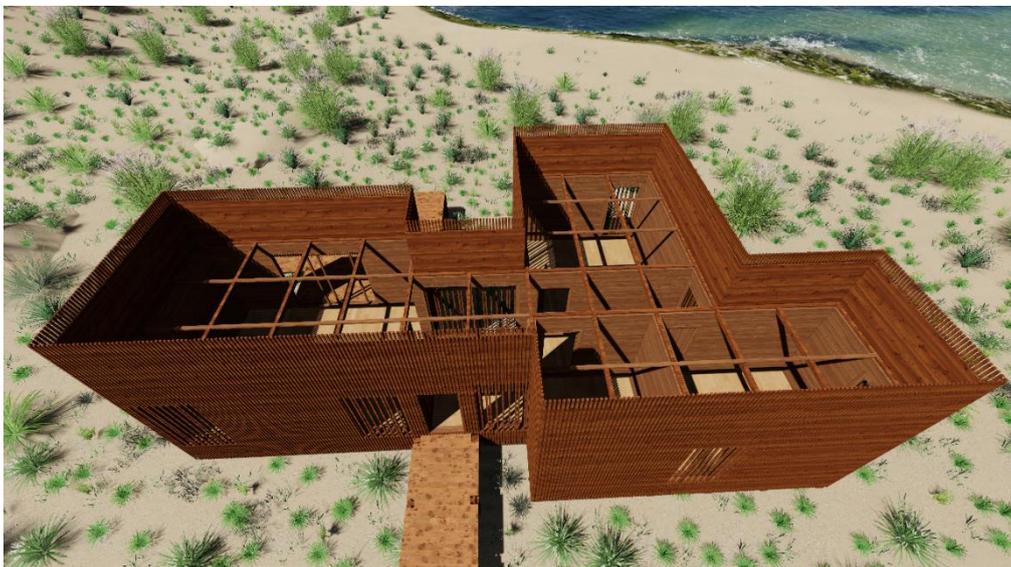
Modelação 3D, alojamento T2, vigas de cobertura – vista 3.
